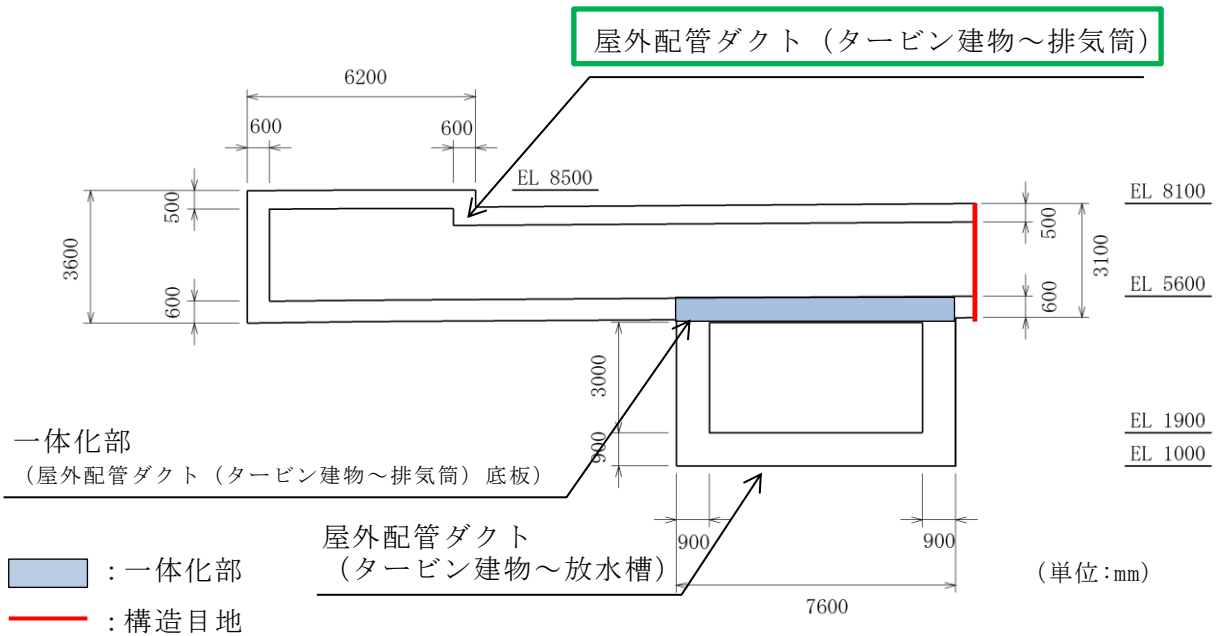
屋外配管ダクト (タービン建物～排気筒) 断面図 (C-C 断面)
